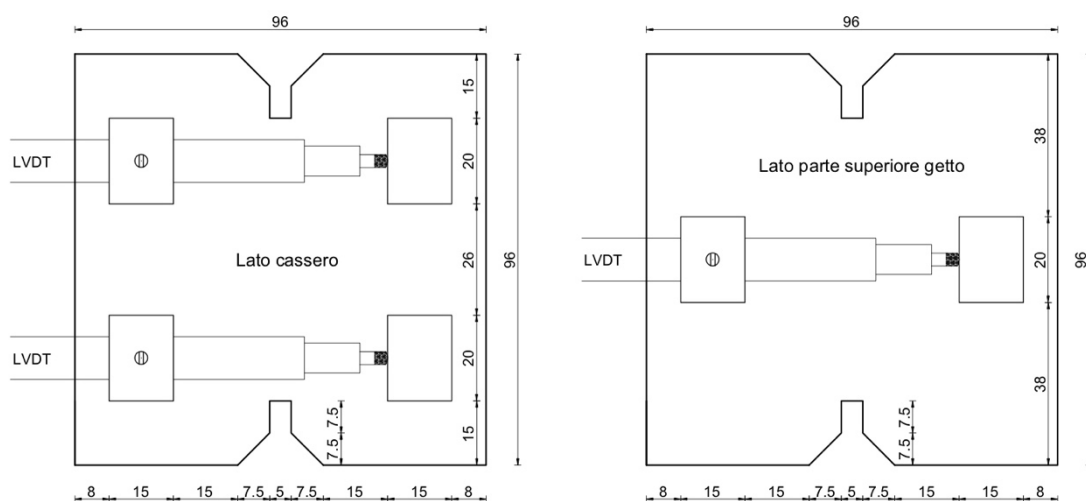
Dimensione campione sottoposto a prova DEWS e posizionamento degli strumenti di misura
